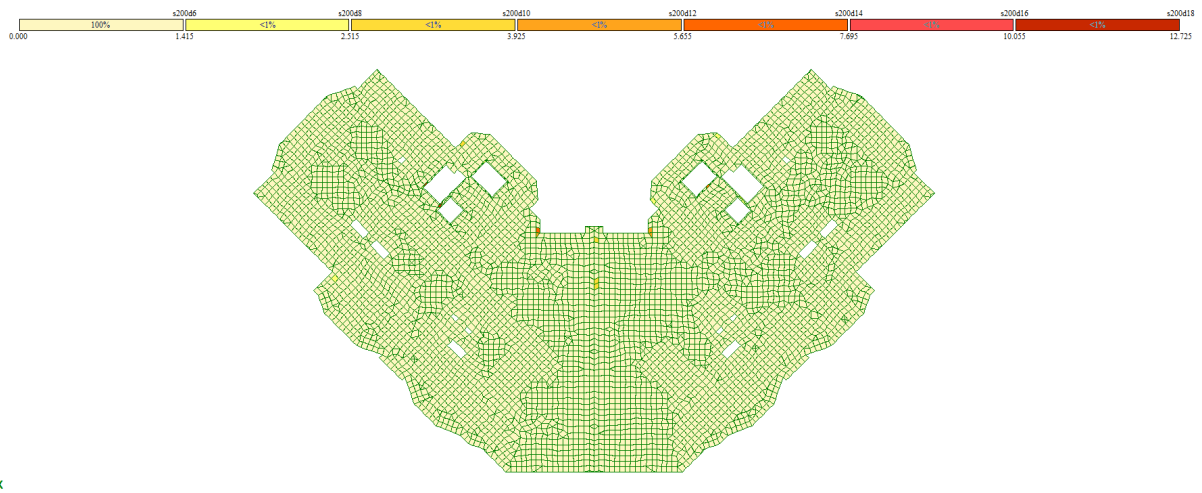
Площа арматури плити на 1 м. п. по осі y (нижня грань)
